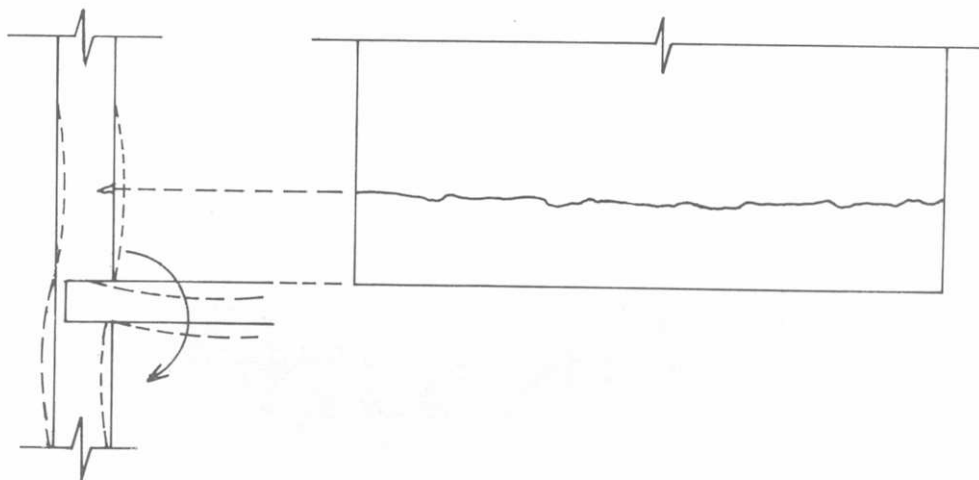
Trinca horizontal na base da parede provocada pela deformação excessiva da laje.
